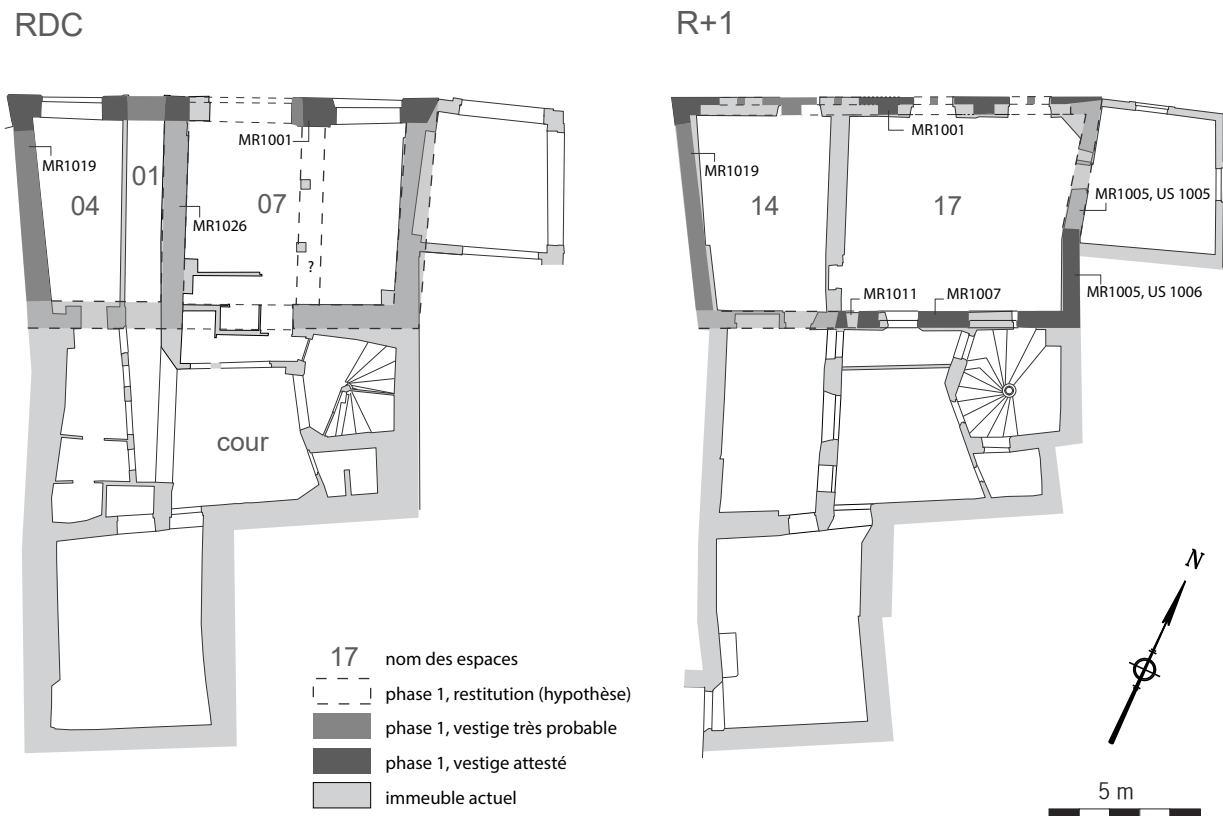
Vestiges de l'immeuble au cours de la phase 1 : rez-de-chaussée et étage unique. Dessin O. Mauftras/Inrap. Fond de plan : SARL NDA.
